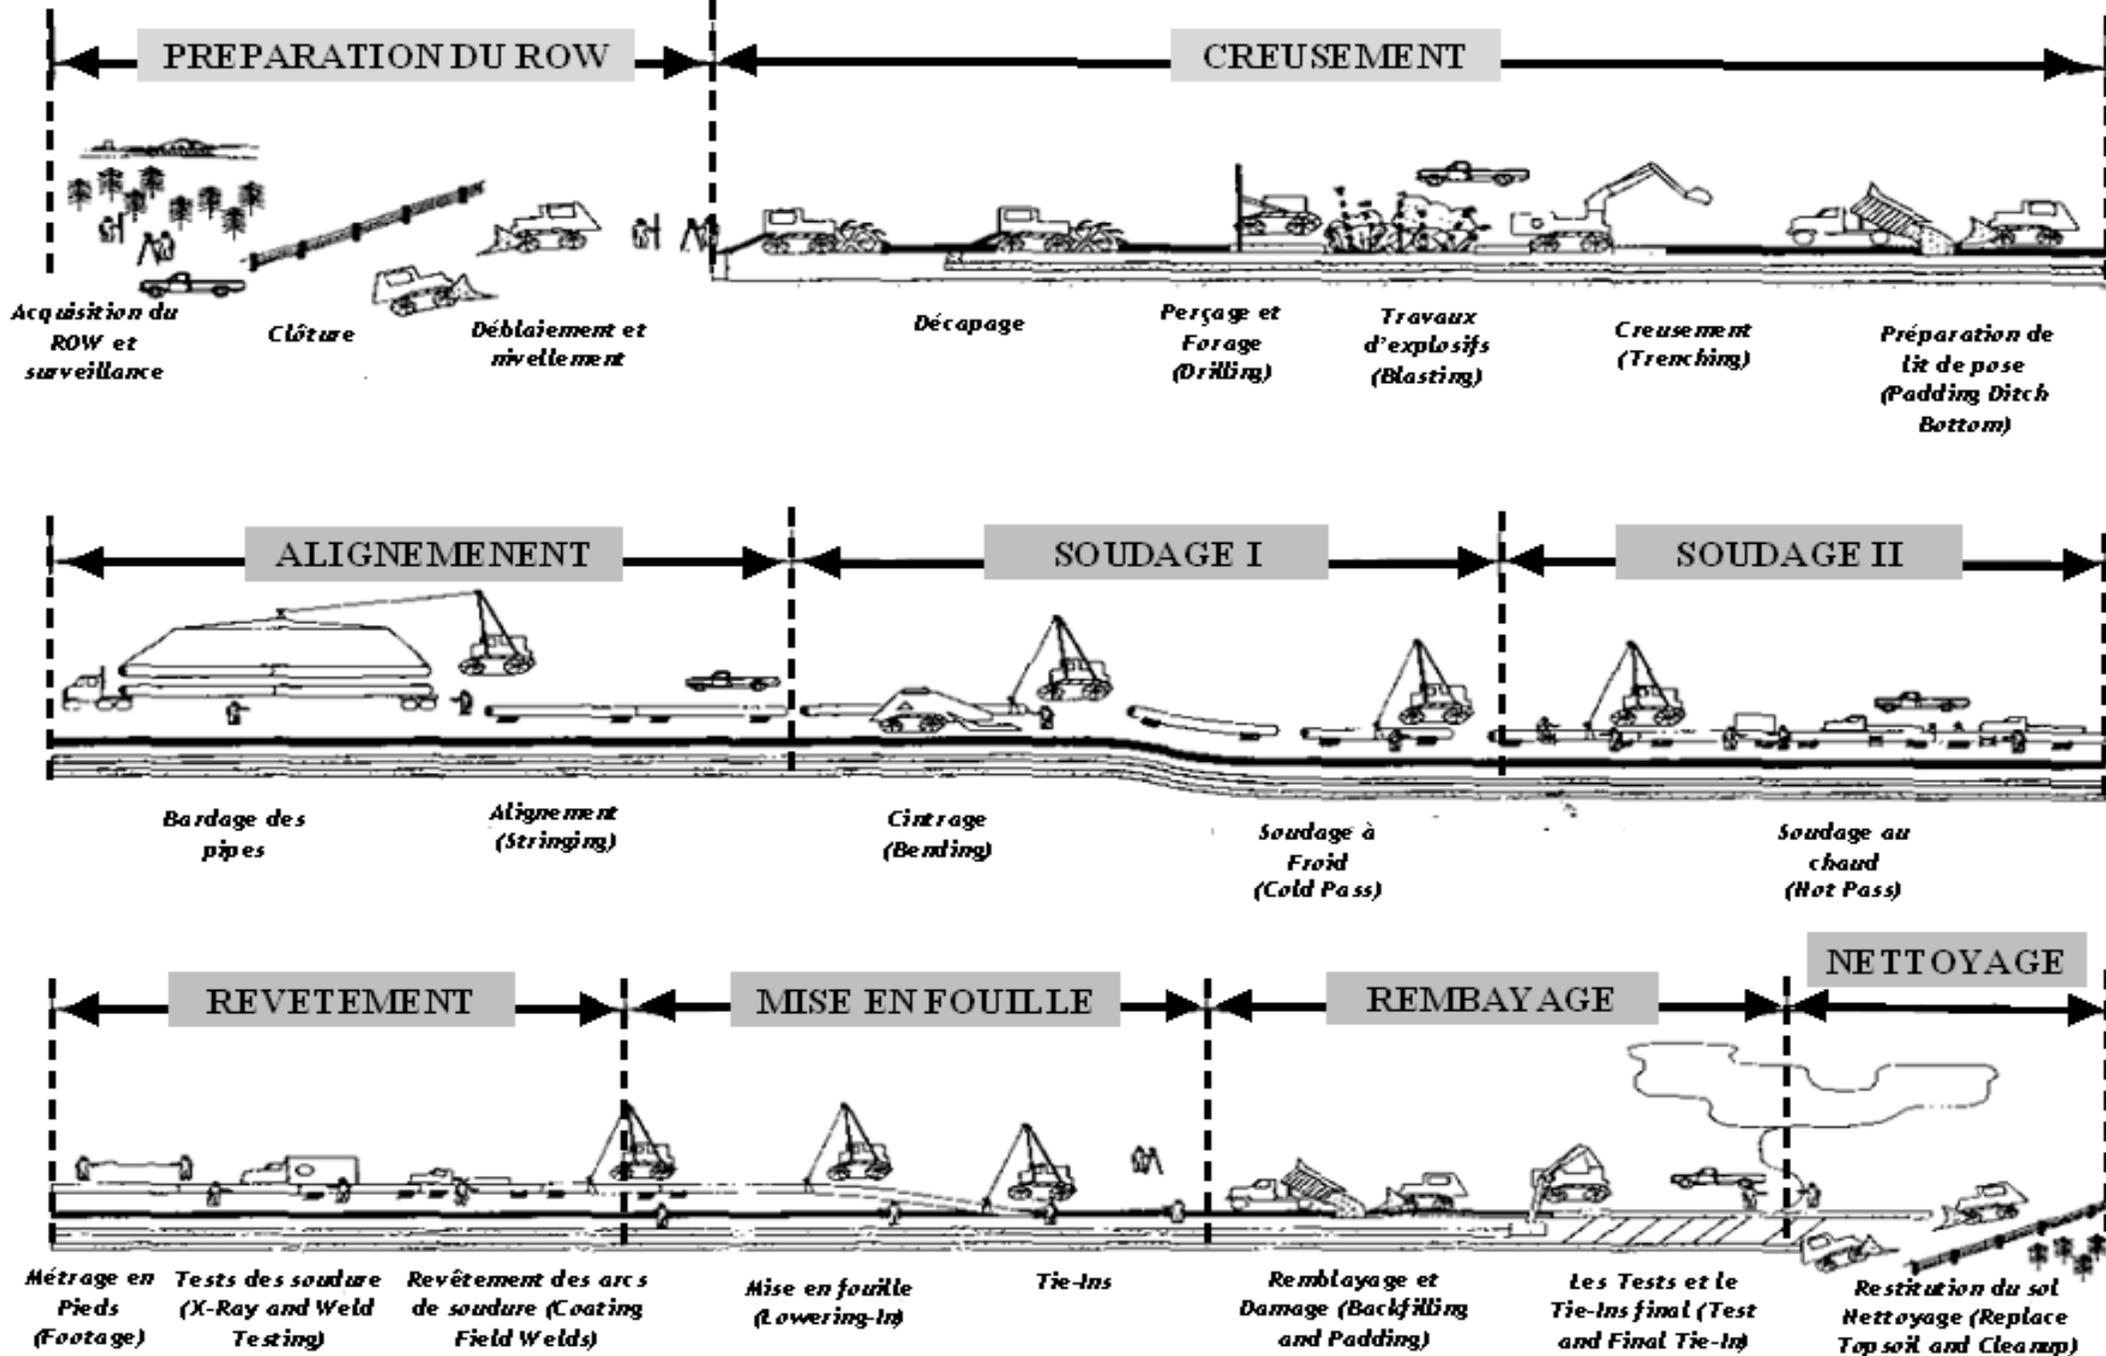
Les typiques spreads pour la construction d'un pipeline
